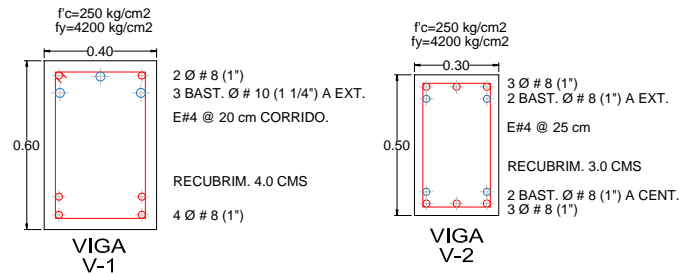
Detallado de armado de vigas del marco de 6 niveles con base a secciones gruesas.
